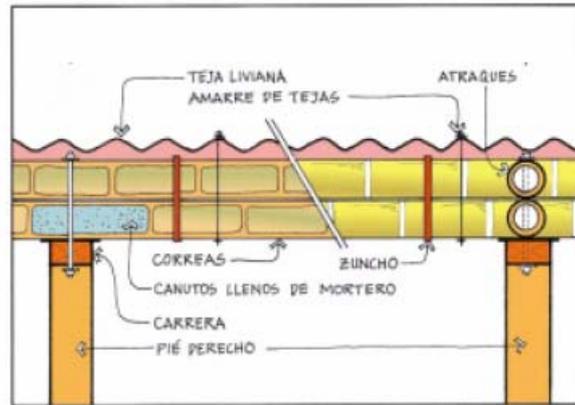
Unión muro-cubierta. Fuente AIS
